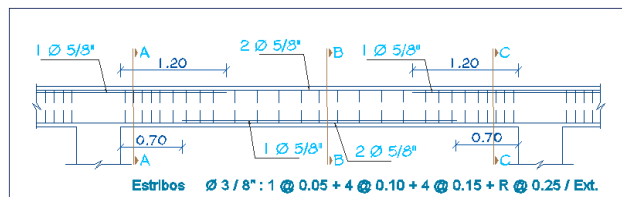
Esquema de la viga principal Pabellón 1C.
